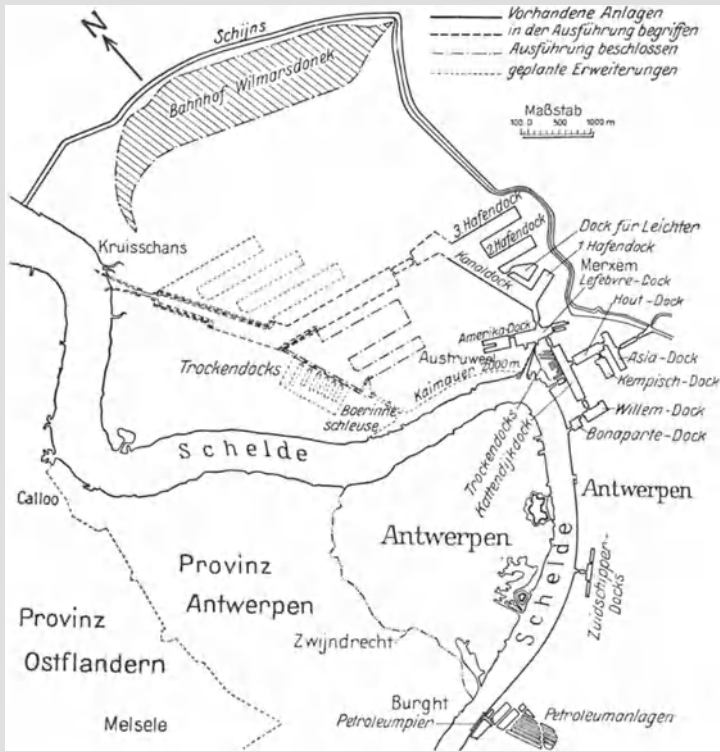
Übersichtsplan des Hafens von Antwerpen mit geplanten Erweiterungen. Offene Scheldekanal. Dockhäfen. Starke Gezeiten. Maßstab 1 : 120 000.
